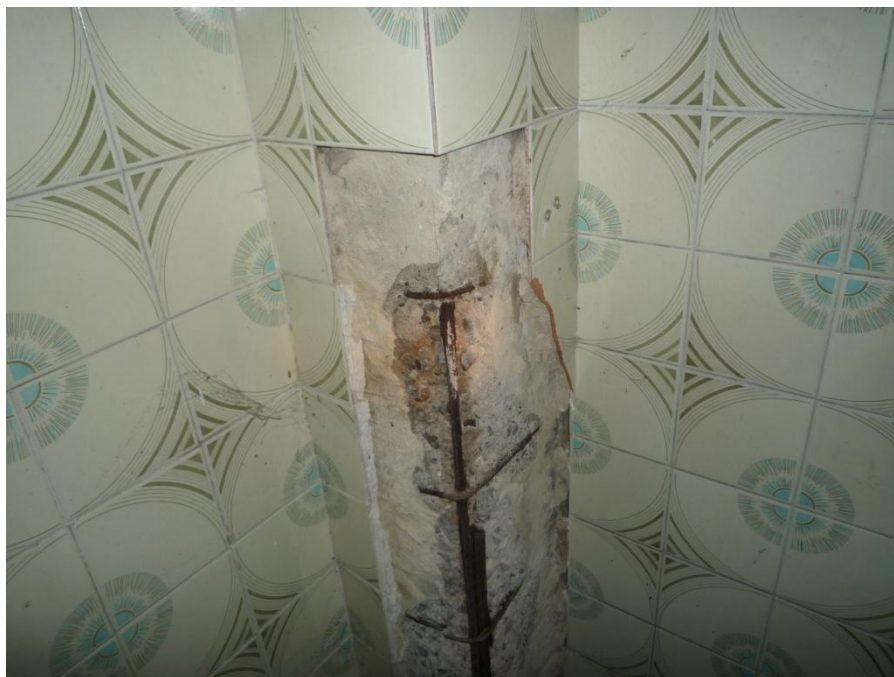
Efectos de la corrosión en un pilar de hormigón armado. Fuente: propia.
